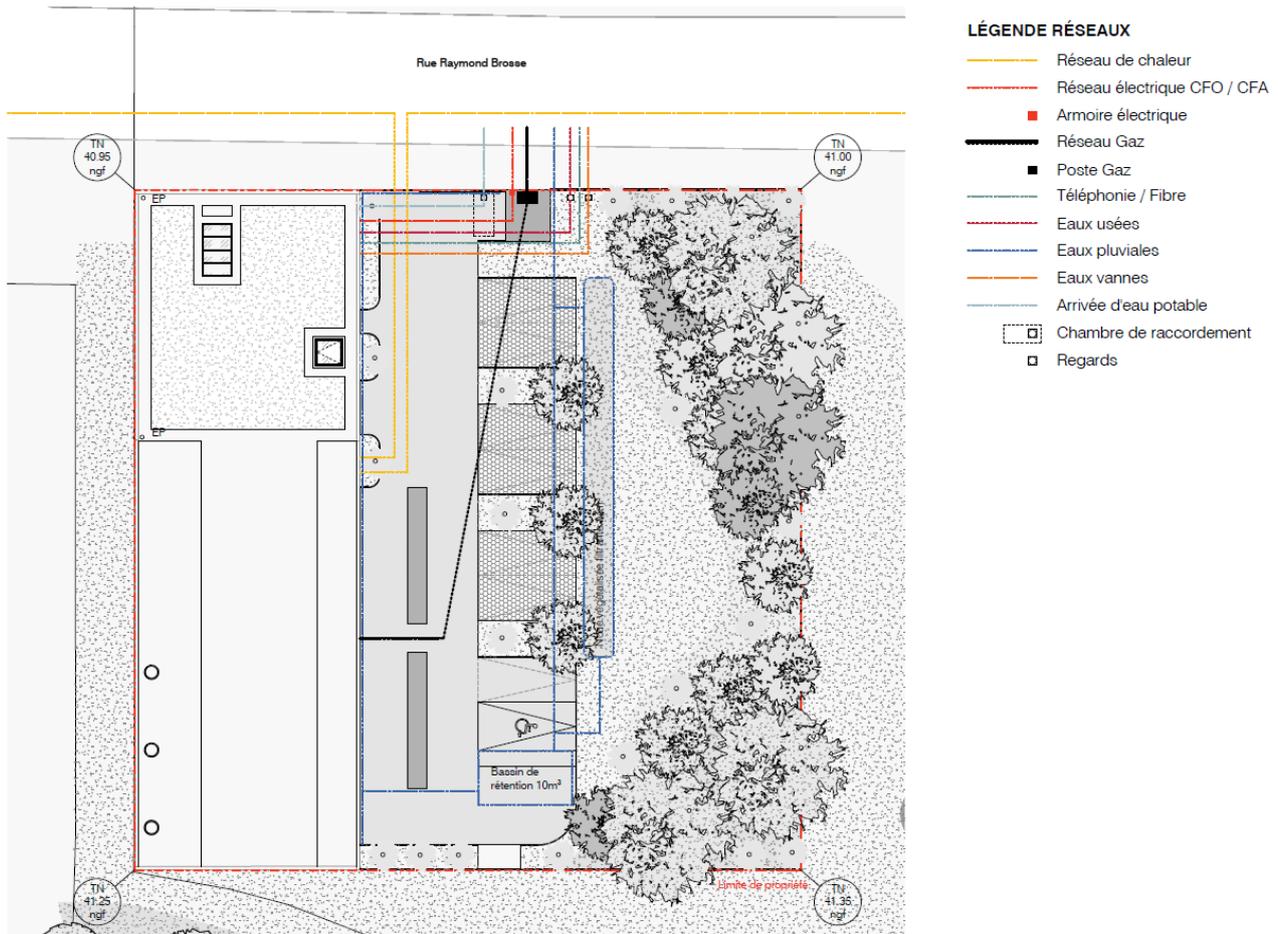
Plan des futurs réseaux enterrés sur la zone chauffière
